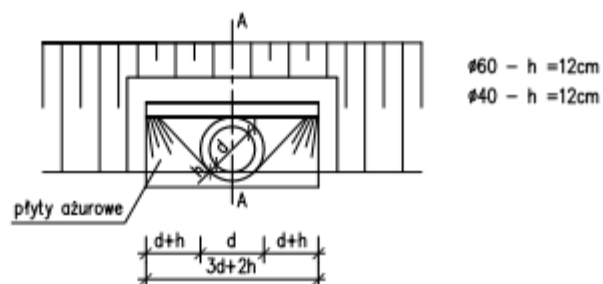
widok konstrukcji przepustu średnicy 400 mm
